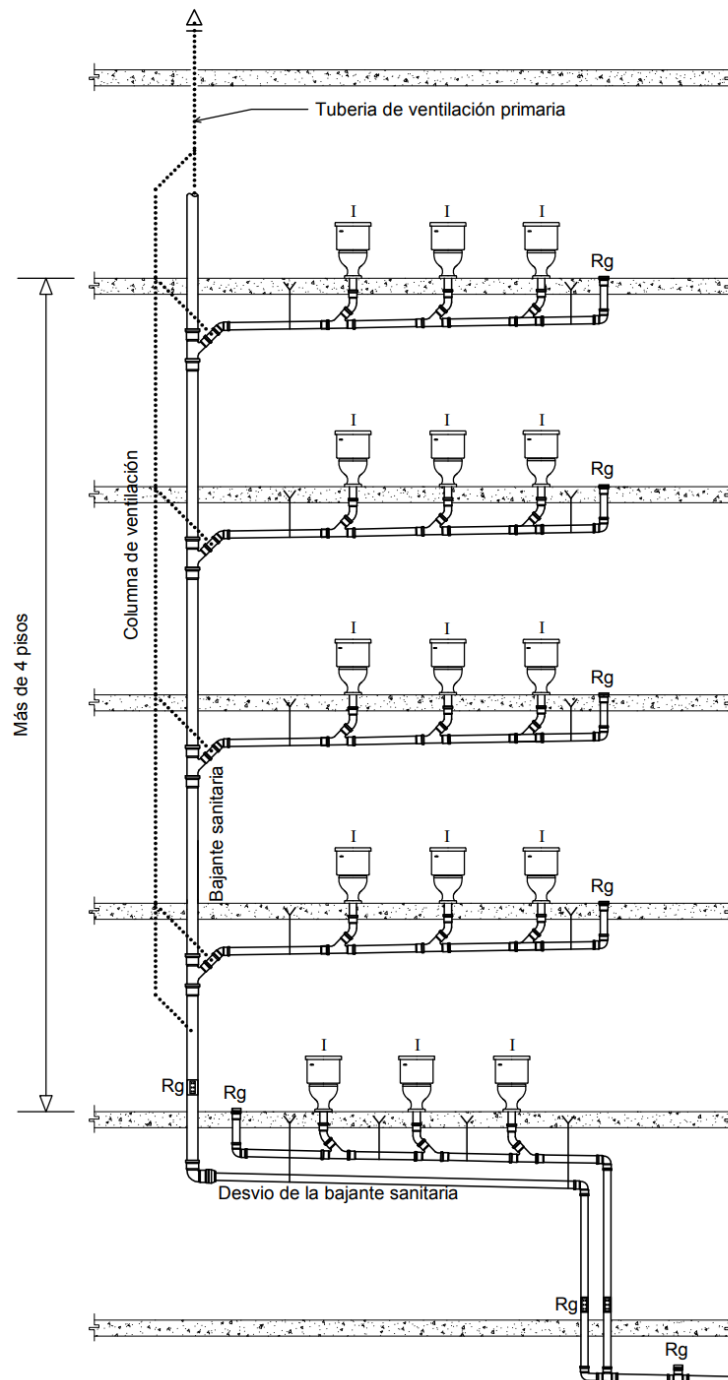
Descarga de ramales sanitarios en un desvío de la bajante sanitaria. Vivienda con más de 4 pisos.
